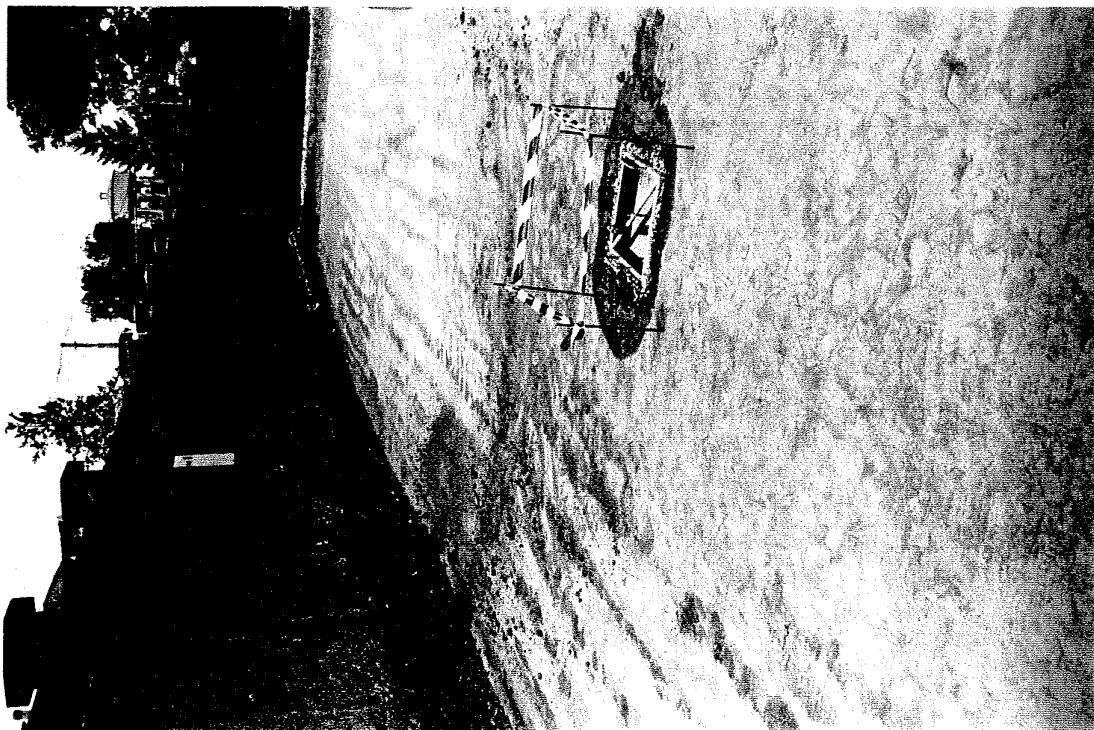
Punto 1 pozzetto di prova della permeabilità in sito.
